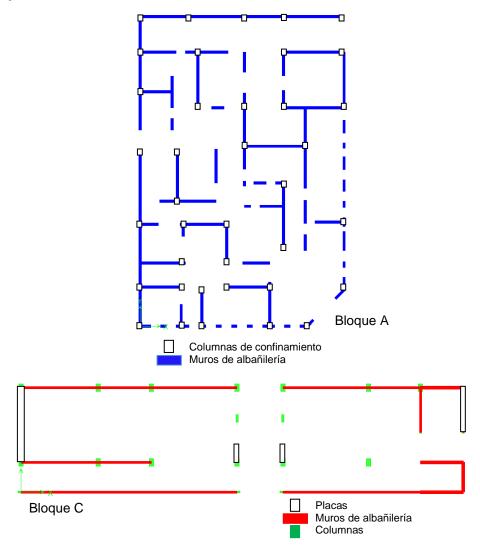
Propuesta preliminar de reforzamiento para los bloques A y C.
